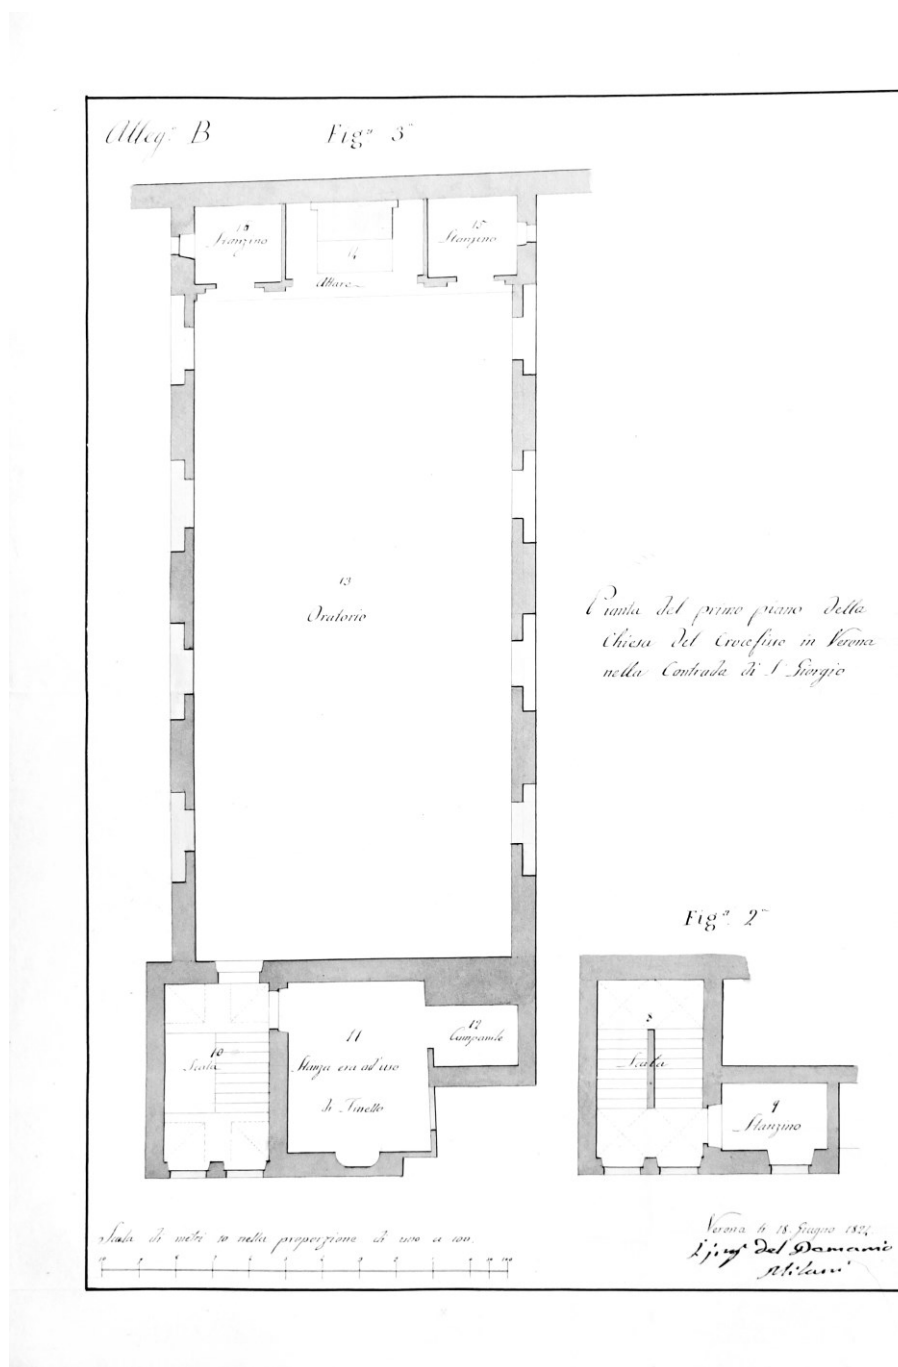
Planimetria del primo piano dell'edificio con l'oratorio del Crocifisso rilevata nel 1824 [Archivio di Stato di Verona, Delegazione provinciale, b. 786].
